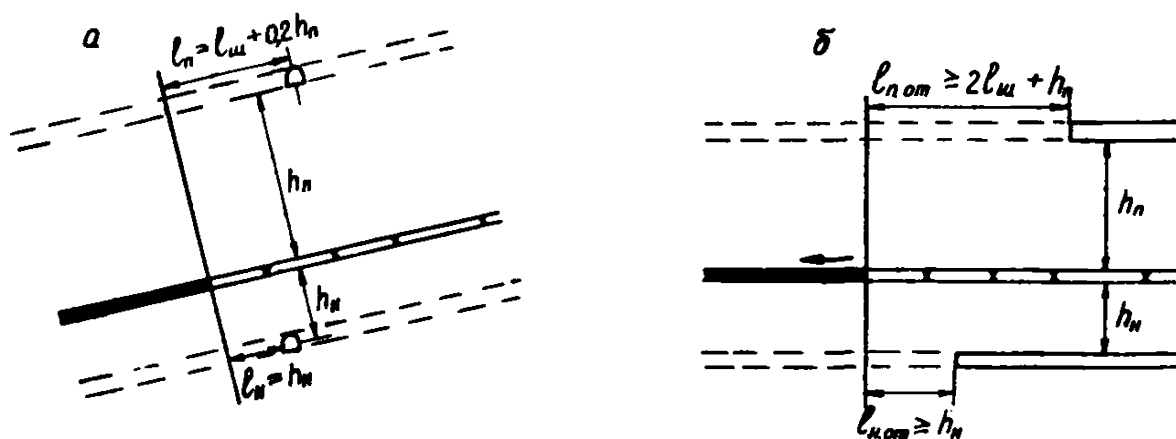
Схемы расположения полевых или пластовых выработок при разработке свит пластов:
